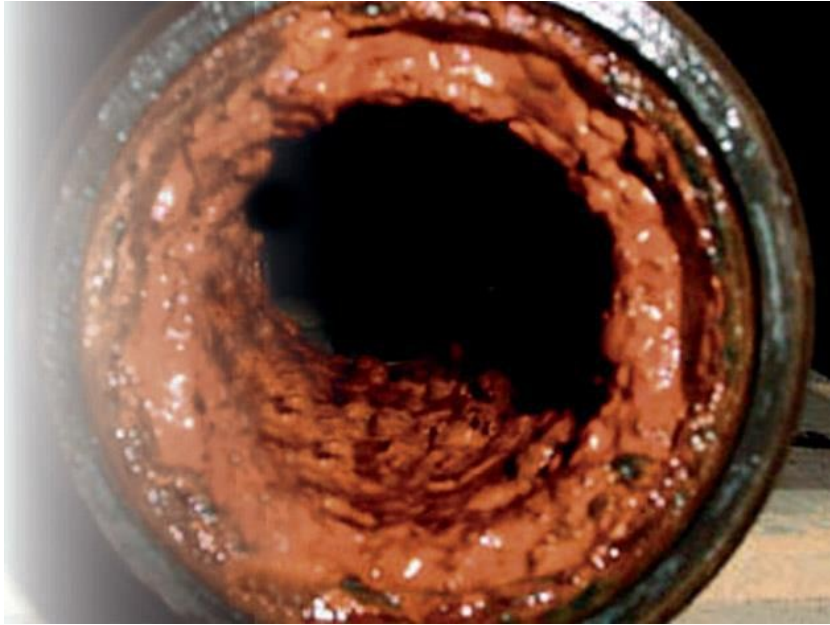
Conduite subi une corrosion (fonte).[9]
